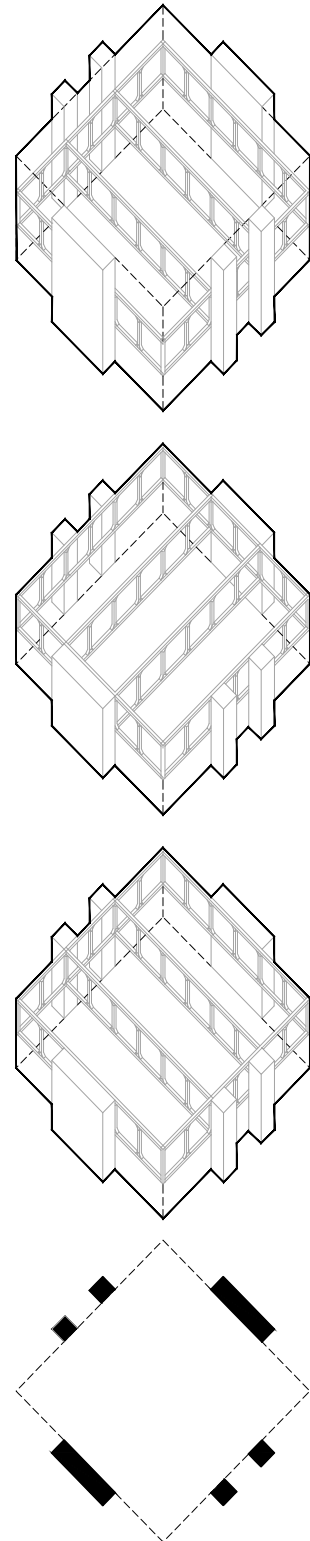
Esquema, vigas viereñdeel acompañadas por núcleos rígidos. Fuente: Elaboración propia.
